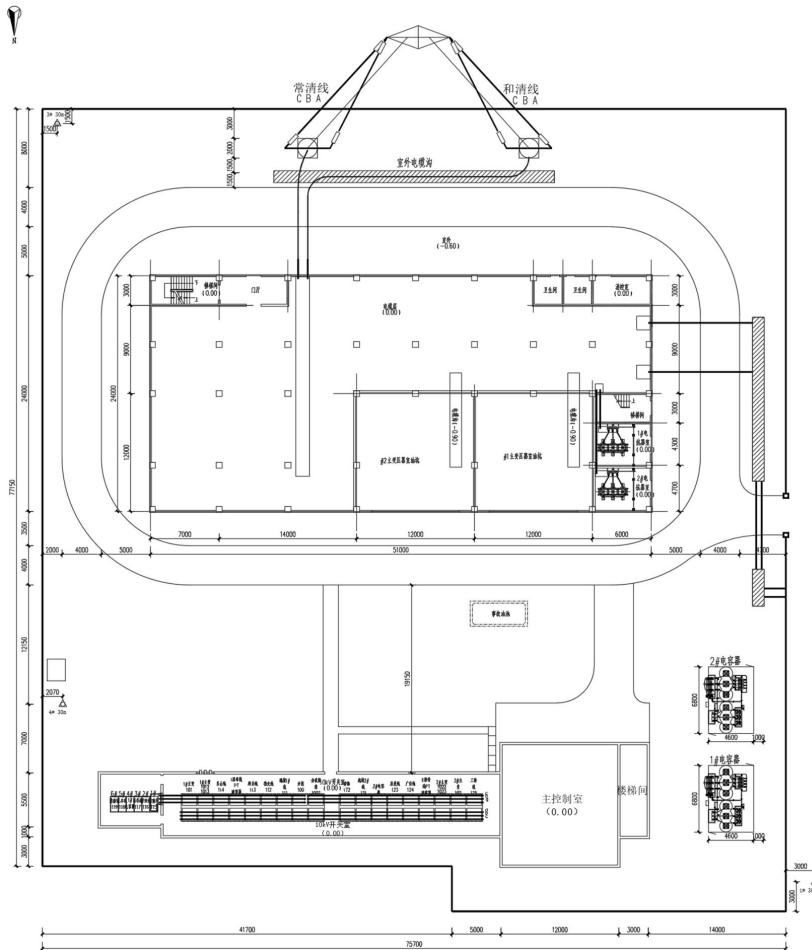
改造后清凉 110 千伏变电站总平面示意图
